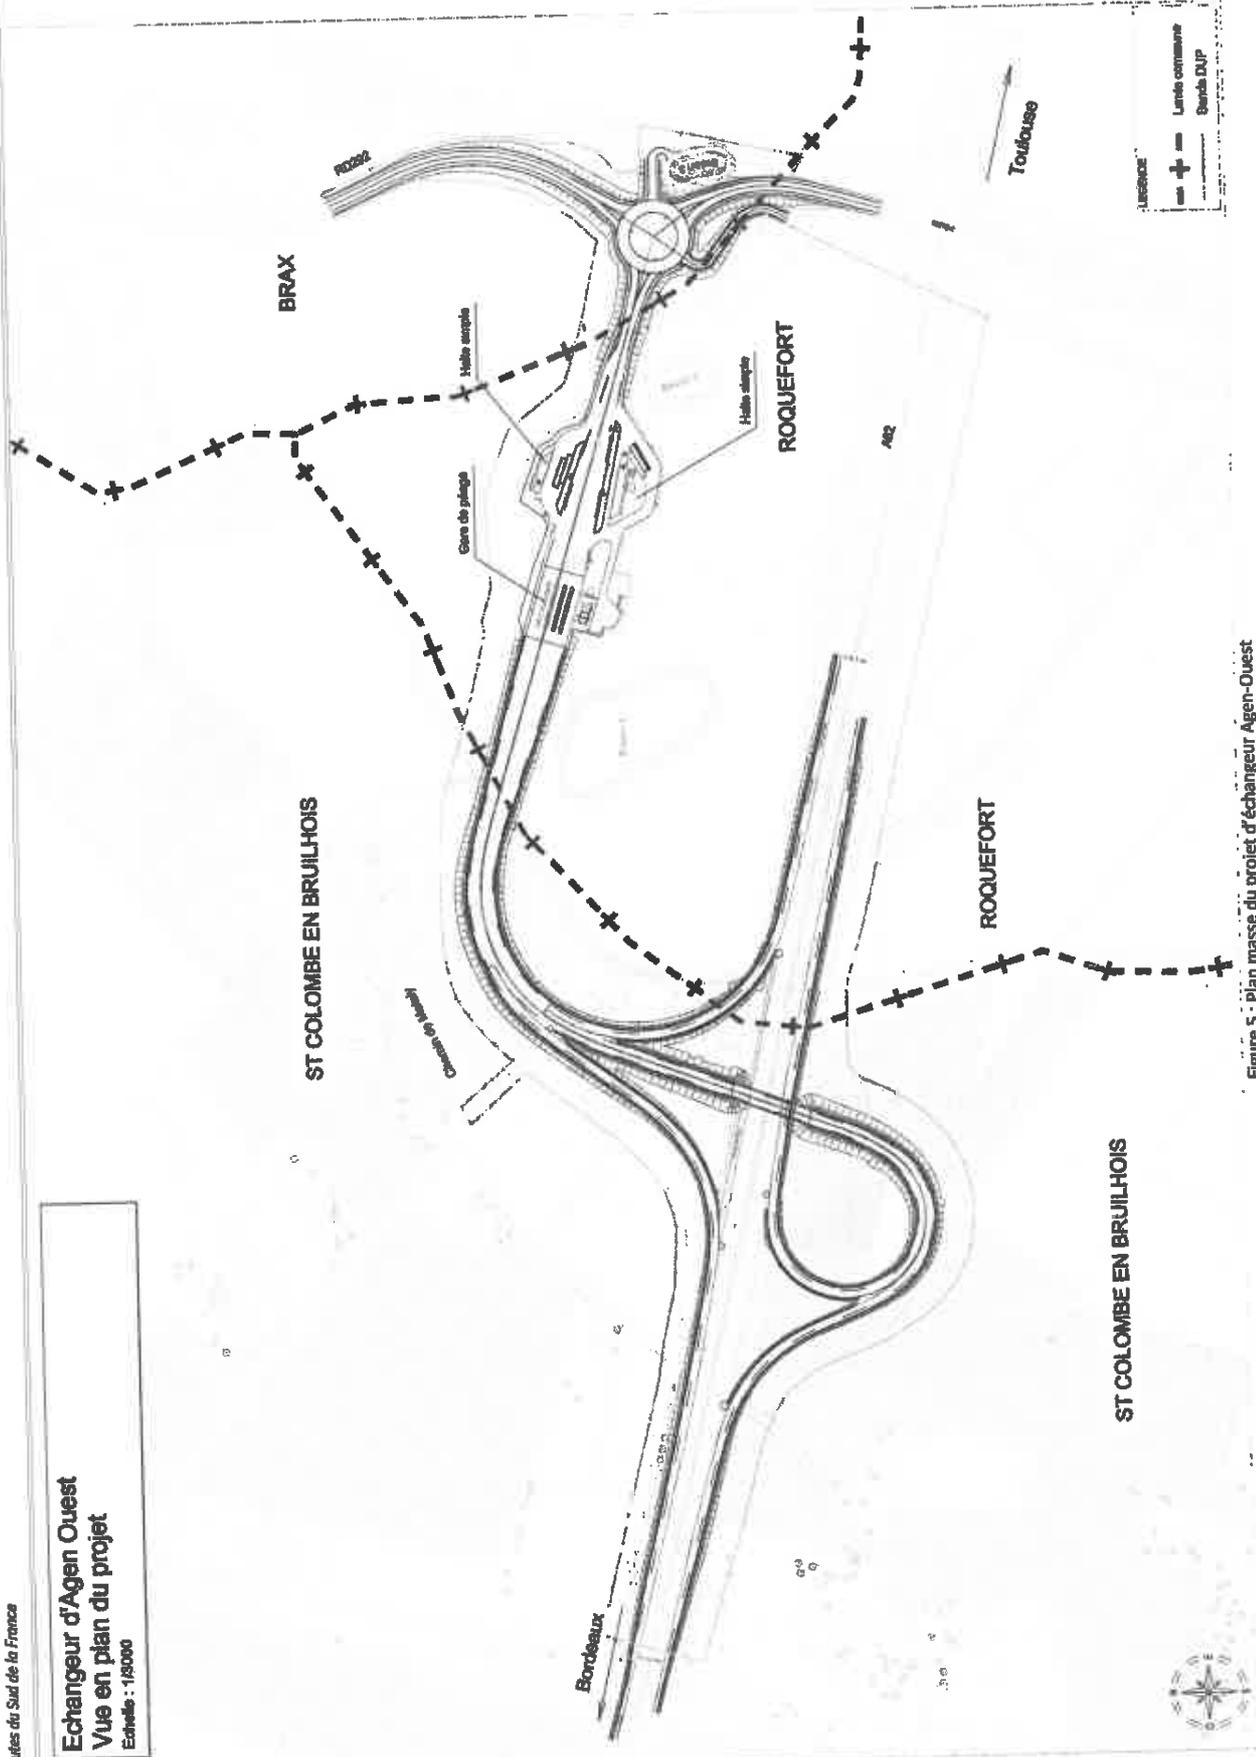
Plan masse du projet d'échangeur Ager-Ouest
